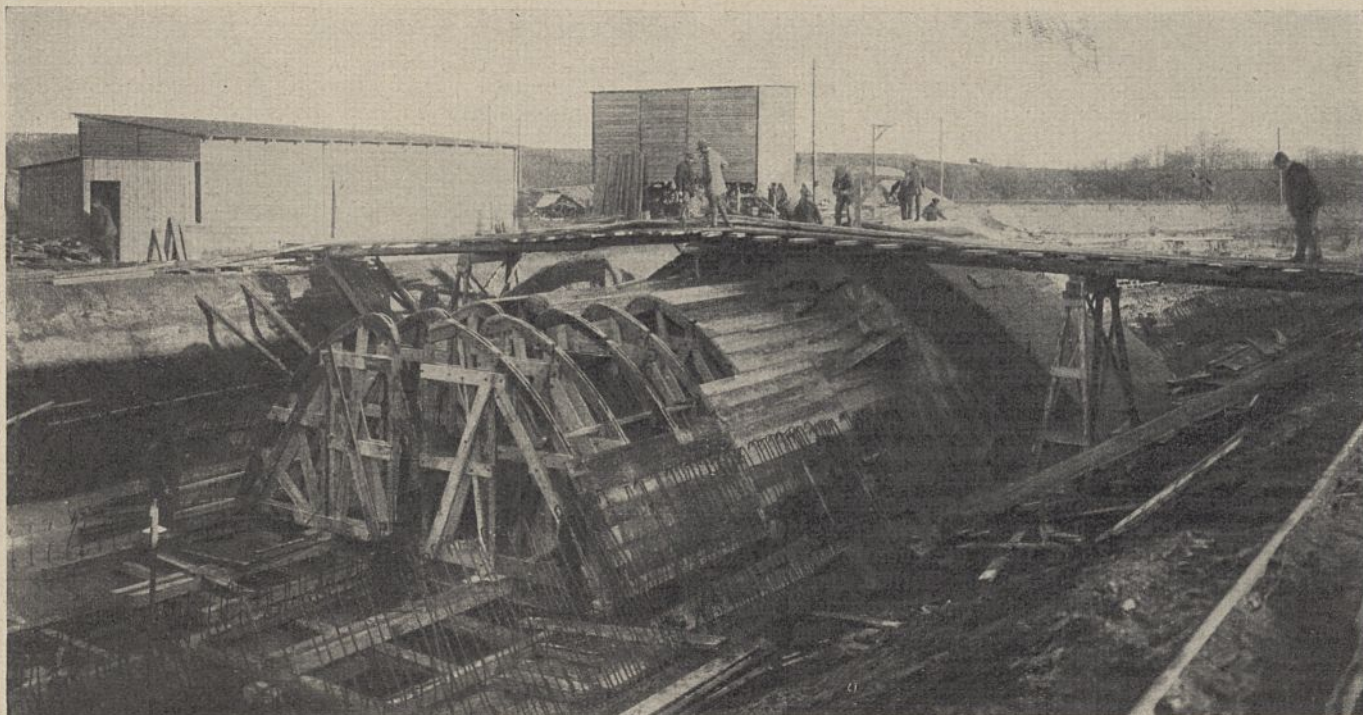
Kraftwerk bei Friedland, Stollen im Bau.
